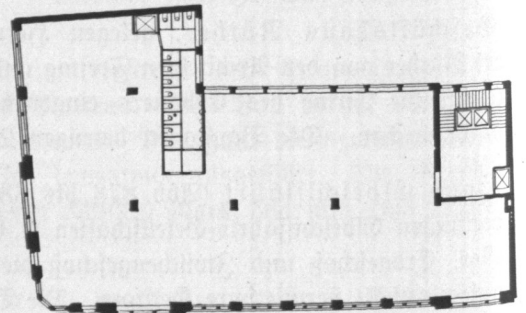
Haus Elbeschiffahrt, Obergeschoss.
